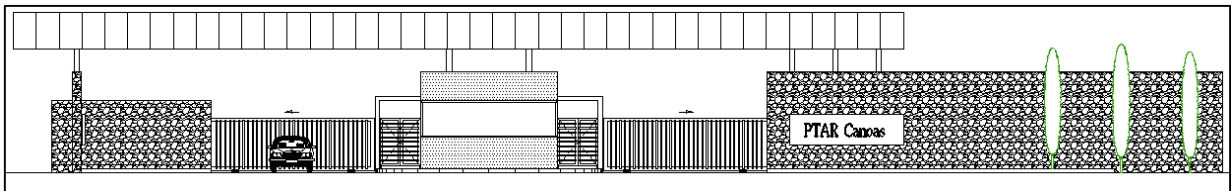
Vista frontal ampliada de las porterías de acceso
